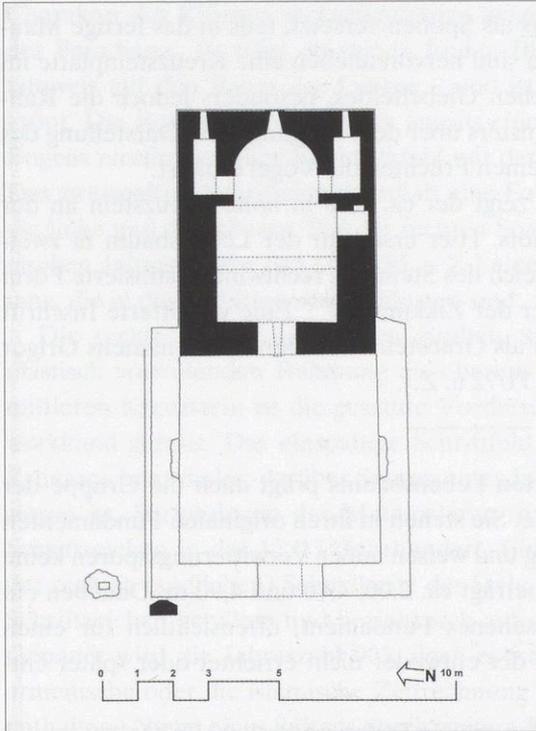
Grundriß Pilgerkapelle auf dem Hügel
